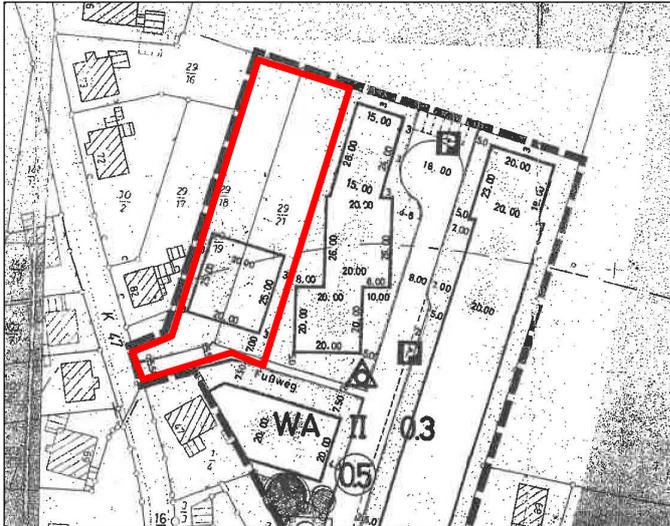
B-Plan Nr. 1 mit Teilaufhebung (rot)
